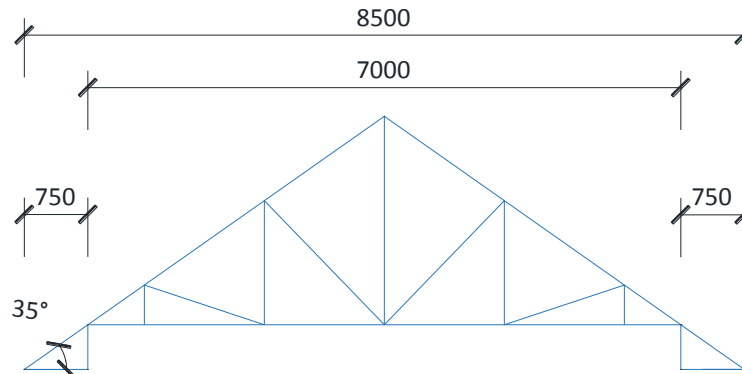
Pembebanan kuda-kuda 1 dan 7 denah B
